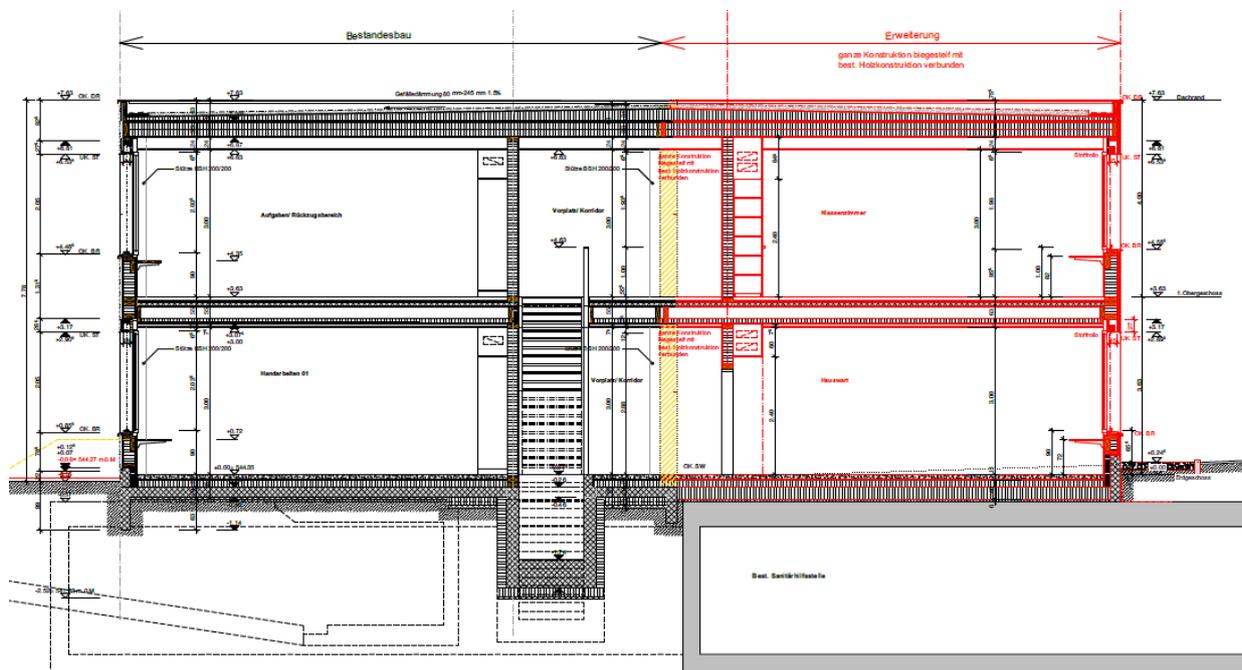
Querschnitt (Planstand TU-Ausschreibung)
